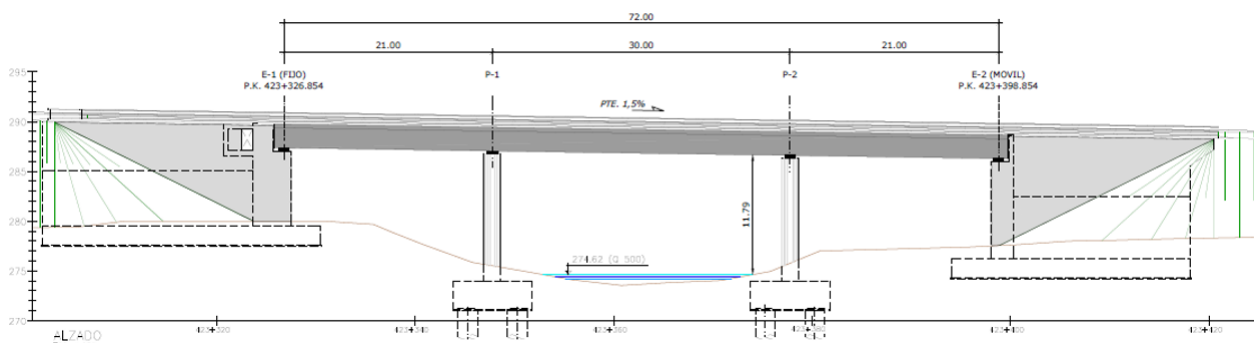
Alzado del Viaducto sobre el Arroyo de los Pelegrines
